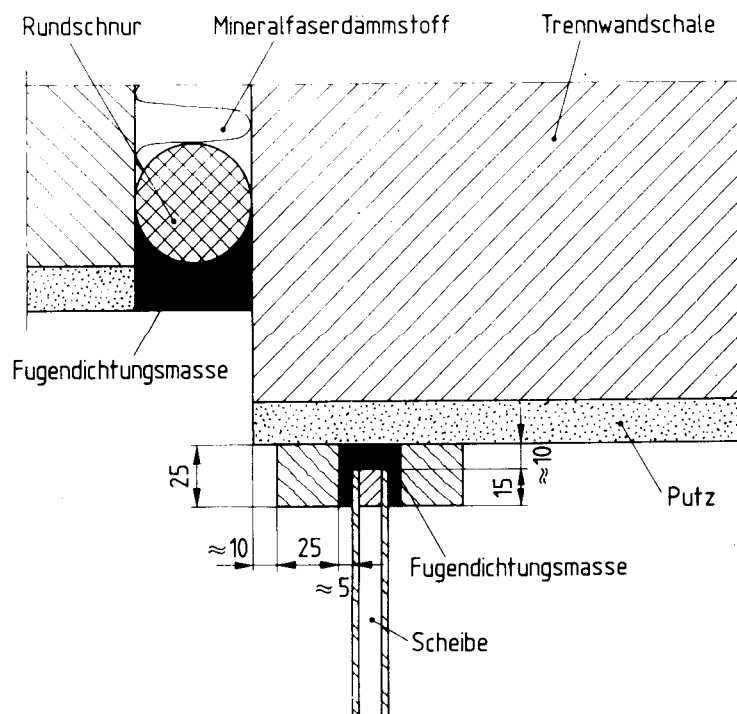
Einbau einer Scheibe stumpf, Einzelheit zu Bild 10
